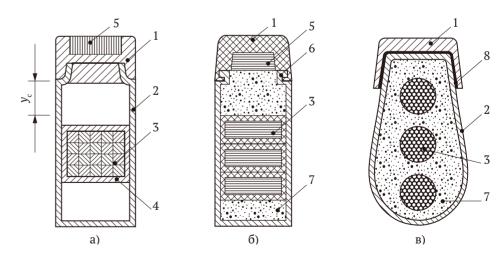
Конструкция рельса-струны (варианты): а – со струной из проволок; б – со струной из лент; в – со струной-канатом; 1 – головка рельса; 2 – корпус; 3 – струна; 4 – защитный кожух струны; 5 – дополнительная струна; 6 – замок-защелка; 7 – заполнитель; 8 – клей
